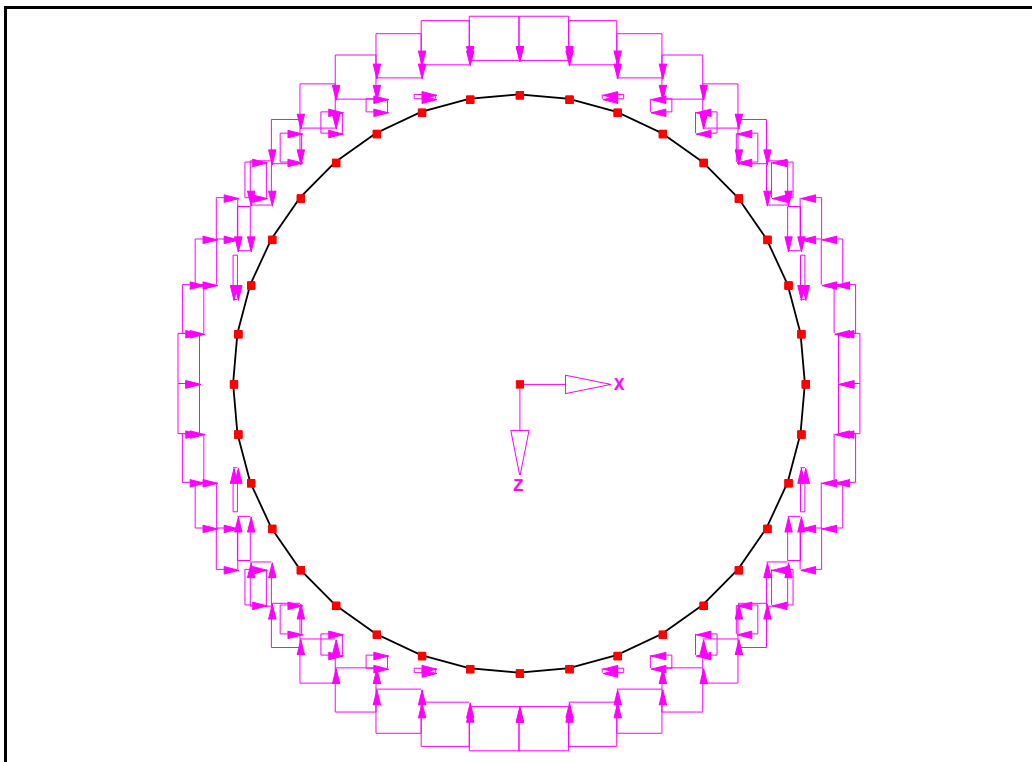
Rohrquerschnitt mit Belastung nach Lagerungsfall 3 [RSTAB]
